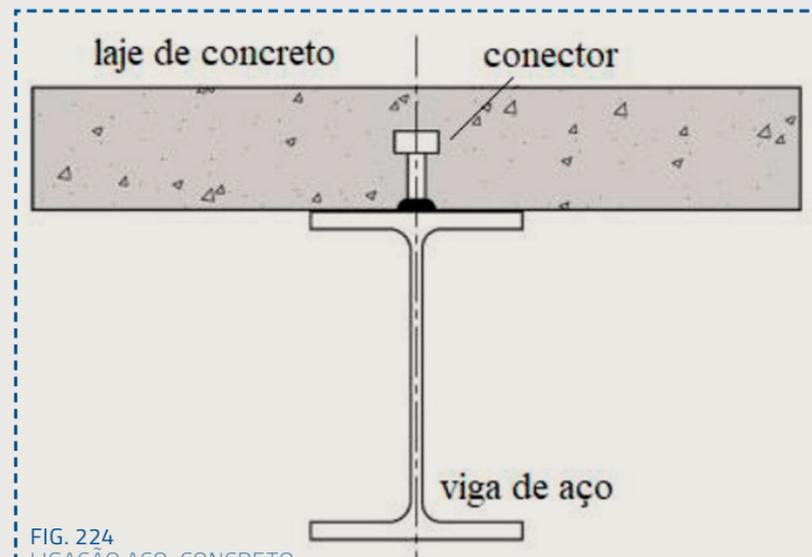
LIGAÇÃO AÇO-CONCRETO. FONTE: RODRIGUES, 2018
